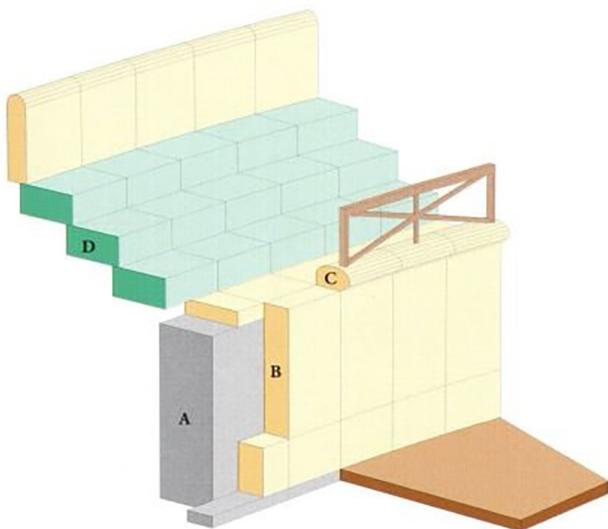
Nyon, anfiteatro (B3). Proposta ricostruttiva del muro del podio (a): b. lastre del rivestimento; c. blocchi a bauletto reggenti un parapetto ligneo (rielaborazione da HAUSER, ROSSI 1999).
